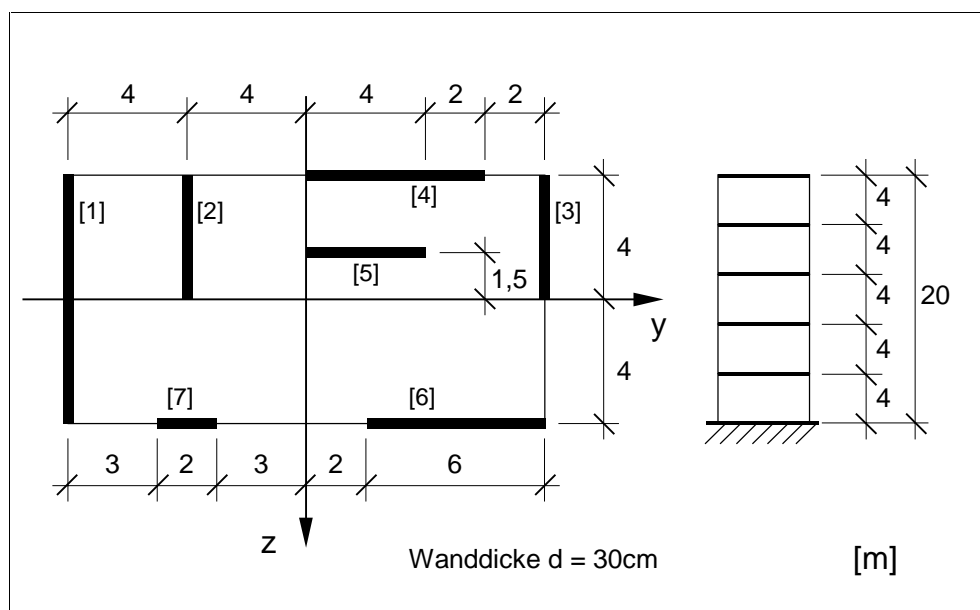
Aussteifungssystem – Grundriß und Gebäudemasse
